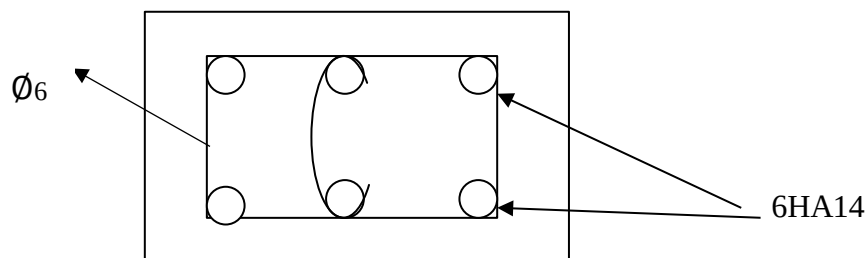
Ferrailage de la section du poteau en compression selon l'EUROCODE
